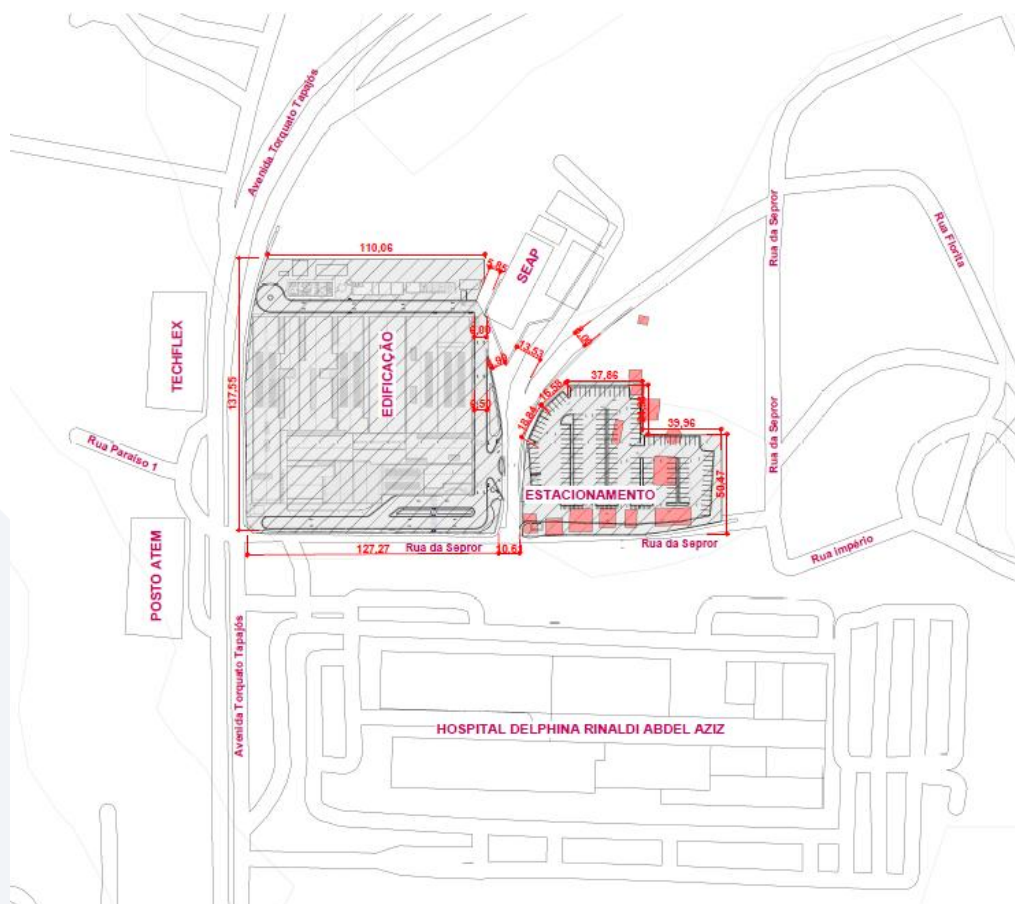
Planta de localização do empreendimento. Fonte: Projeto de localização, 2025.
